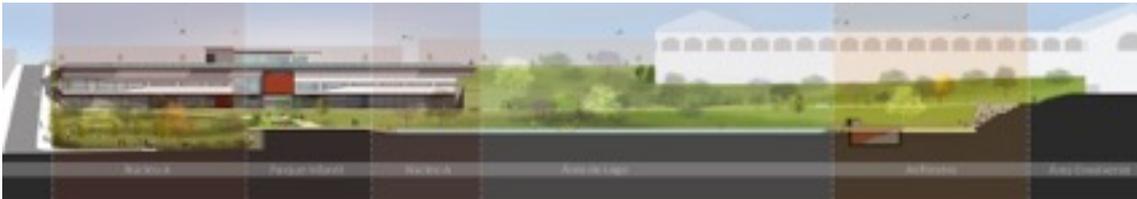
Corte bb' longitudinal. Sem escala. Fonte: Autor
